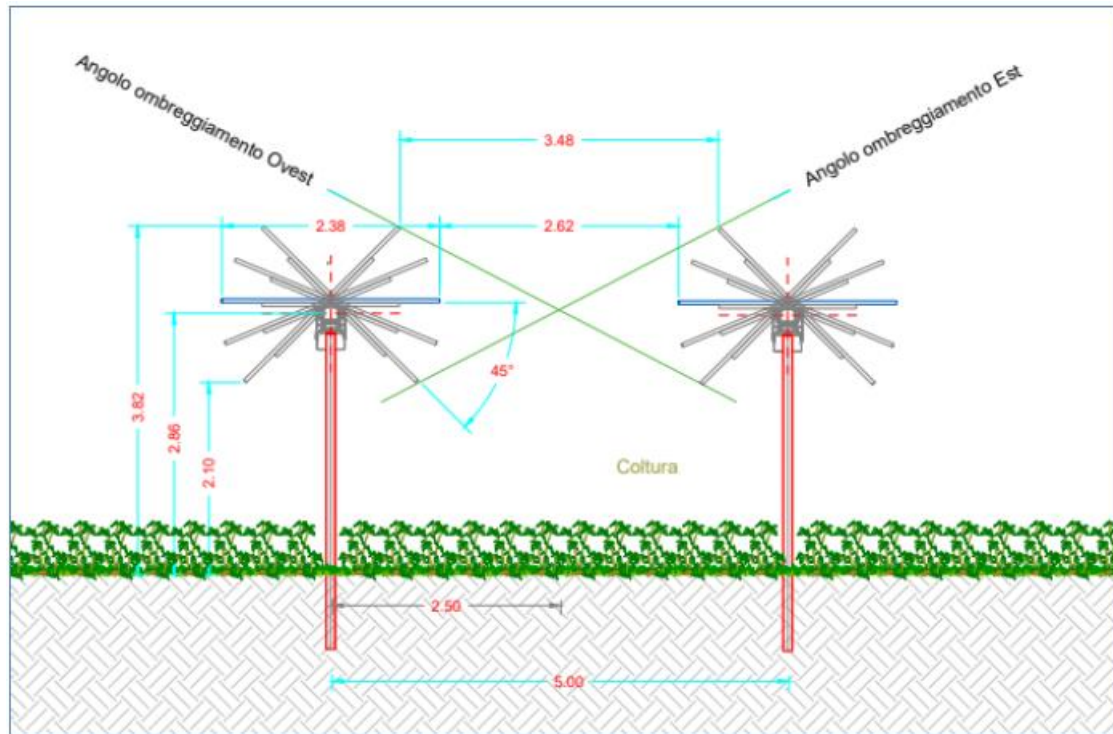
Sezione trasversale tipologica struttura Tracker con erbaio
